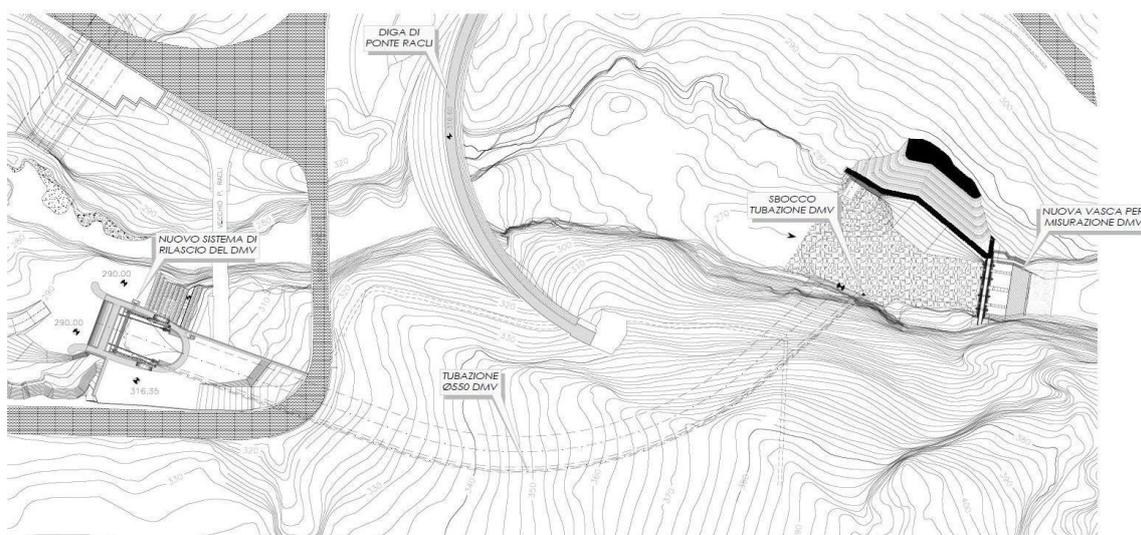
Planimetria nuovo sistema di rilascio del DMV
